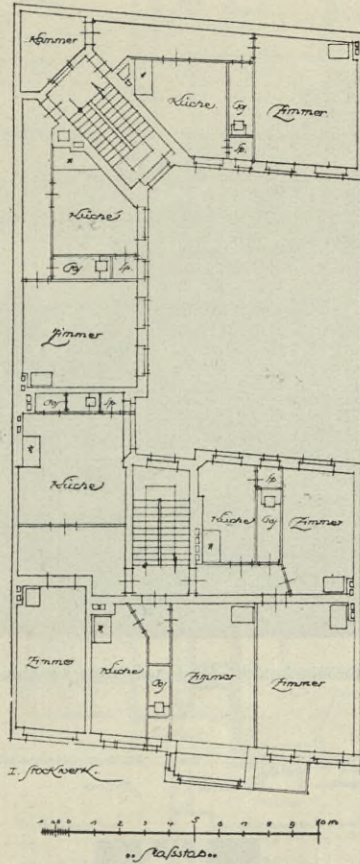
Typisches Wohnhaus, Grundriß aus dem Norden Berlins
